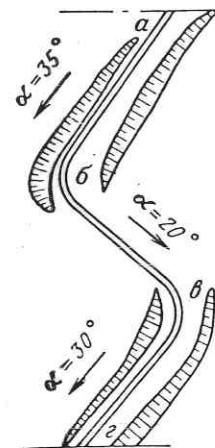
Схема монтажа трубопровода на уклоне с поворотами в плане
